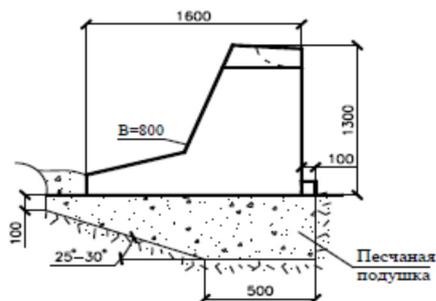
Железобетонный асимметричный фундамент с горизонтальным размещением подошвы
